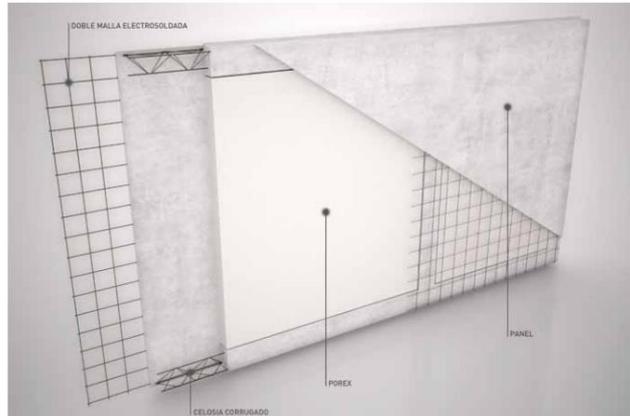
Imagen tipo de panel de hormigón para cerramiento de fachada. Fuente TECNYCONTA
